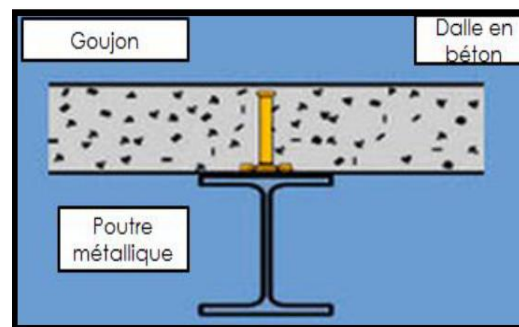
Technique d'attachement (dalle en béton et poutre en acier)
